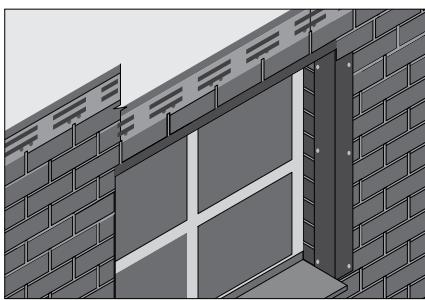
Монтаж фасадной плитки поверх оконного наличника сверху проема
